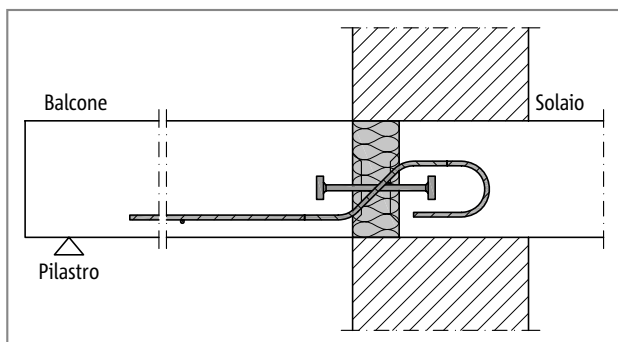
Schöck Isokorb® tipo QP20S: balcone con appoggio su muratura monostrato
